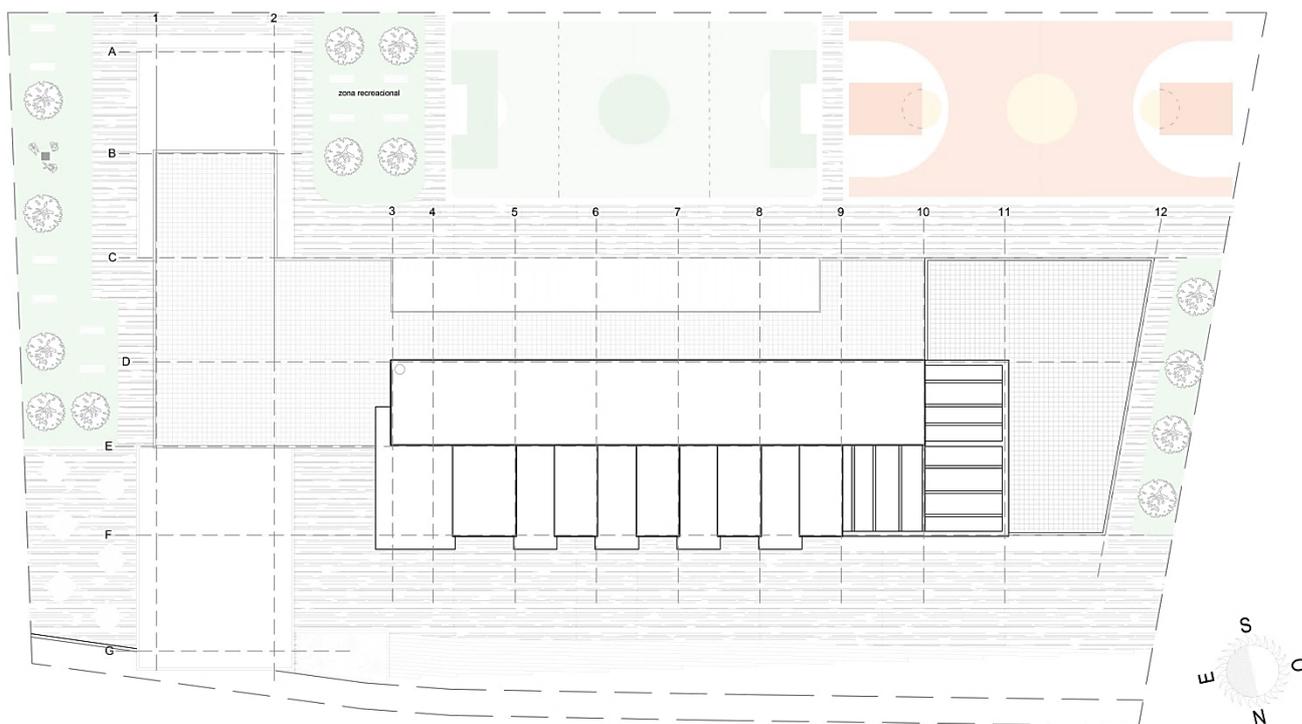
Planta: piso 8 Cevallos. (2018). Creación propia
